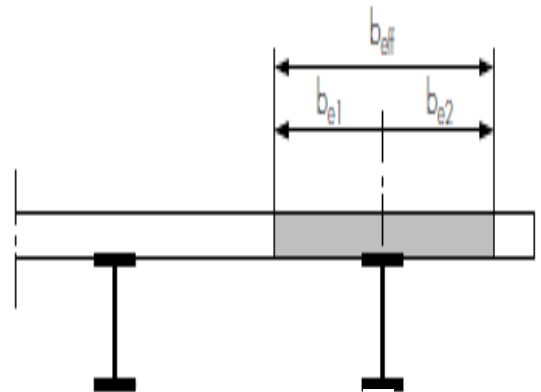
Largeur effective de la dalle pour une poutre mixte
